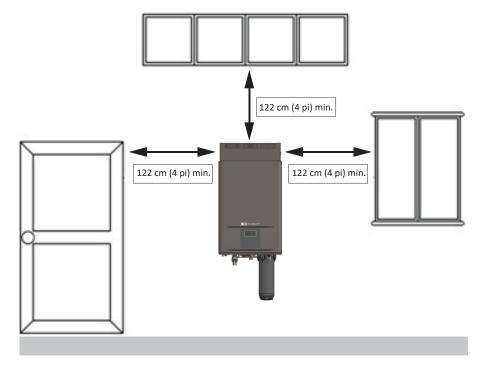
Dégagements minimum d'évacuation (installation extérieure)
